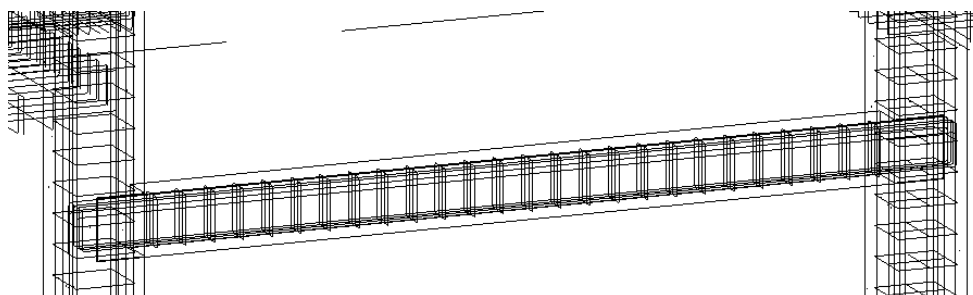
Detalhe da armadura da viga 1 do rés-do-chão (solução estrutural 1) no Revit.
